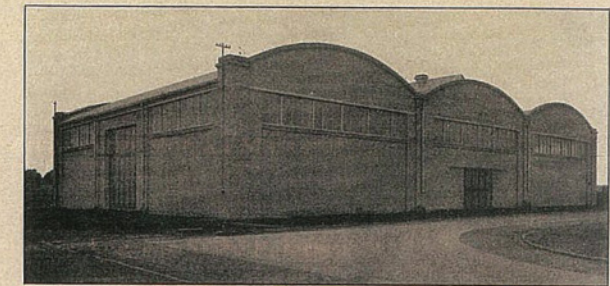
Äußeres einer dreigeschossigen Halle mit gebogenem Junkers-Dach.
